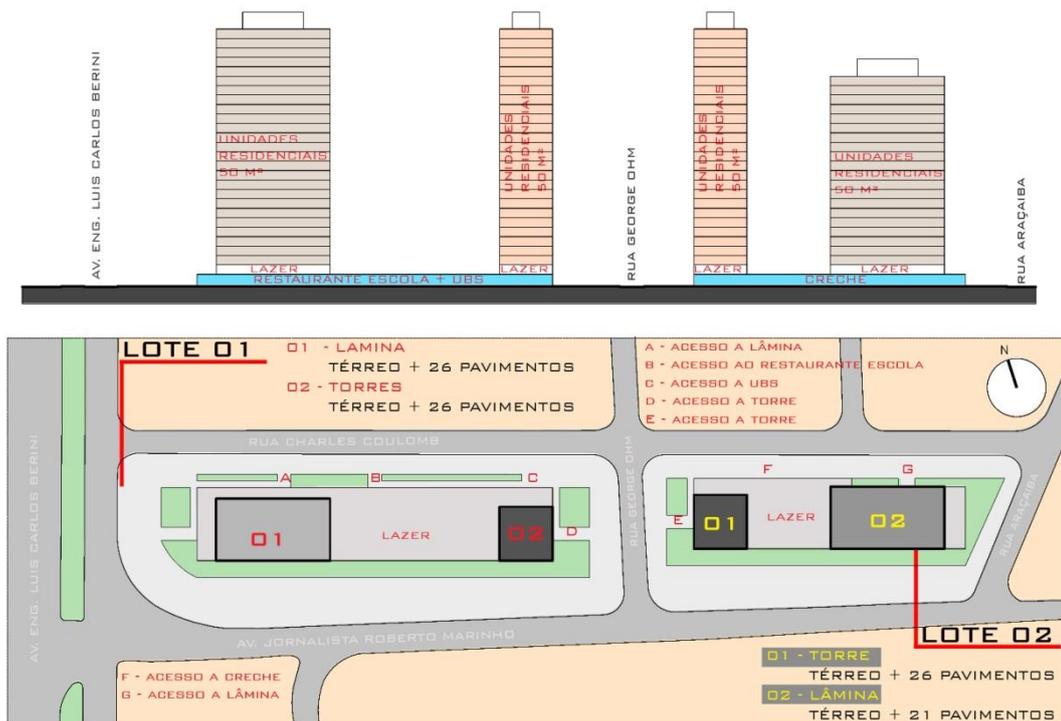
Implantação esquemática demonstrando a implantação para os dois lotes no Plano Diretor de 2014 em ZEIS 03. Fonte: Acervo do Autor [2014].
